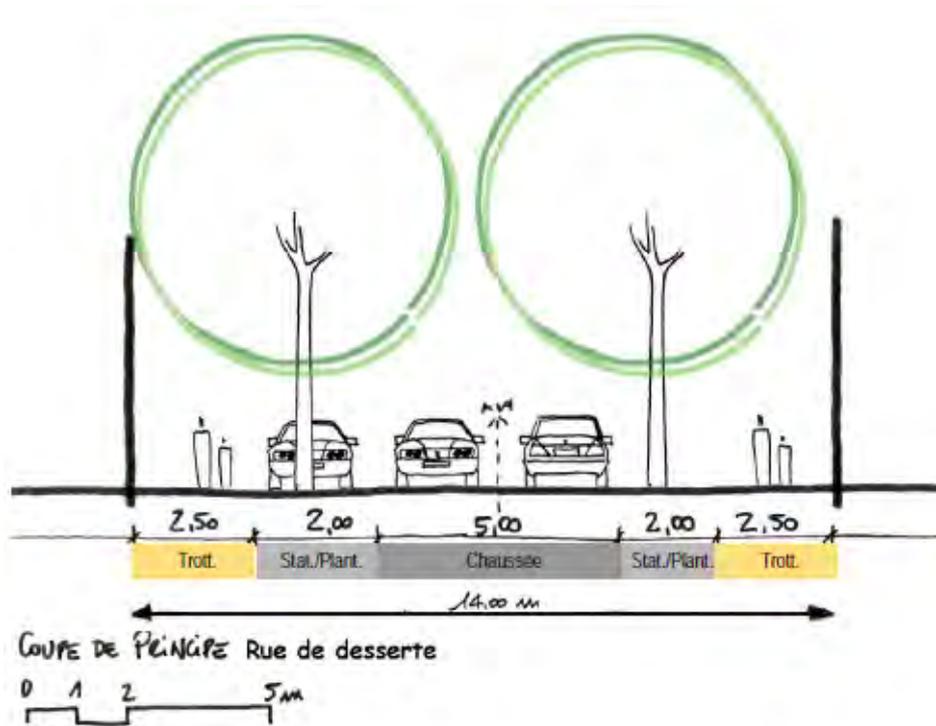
coupe de principe rue de desserte. Atelier Marguerit
